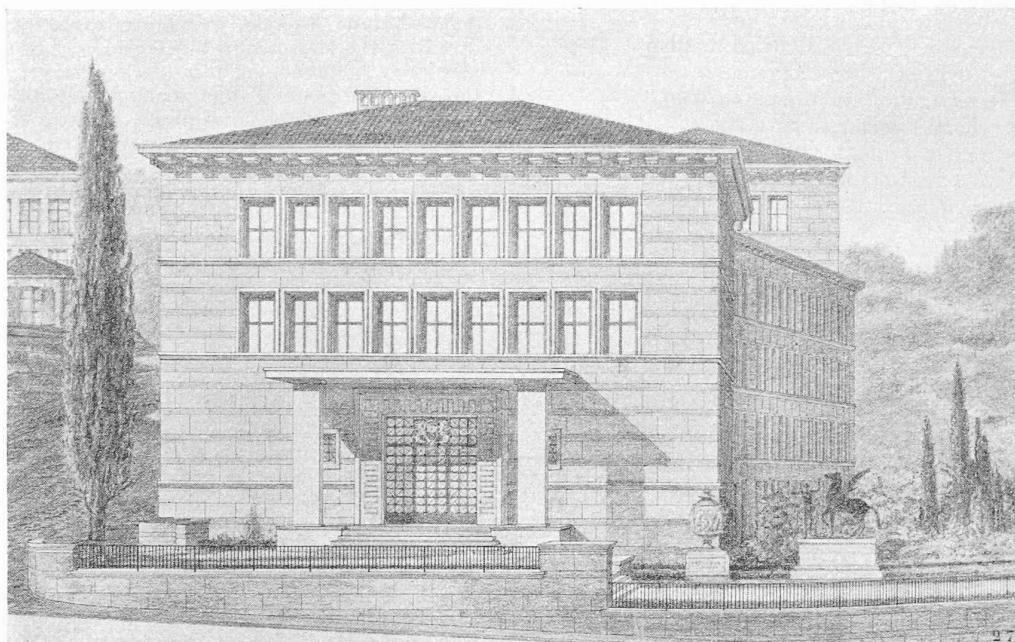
Façade sud du projet de bâtiment à la Cité, par A. Laverrière, architecte.
